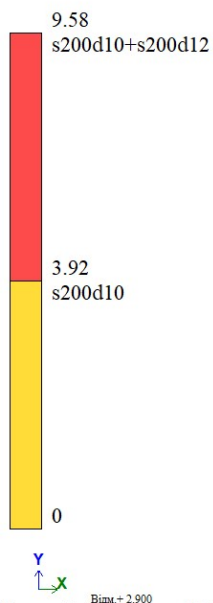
Армування плити перекриття по верхній грані вздовж осі X
